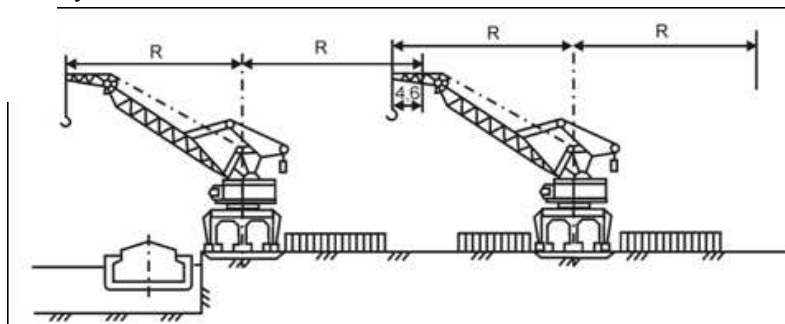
Схема механизации перегрузки штучных грузов с использованием порталных кранов
